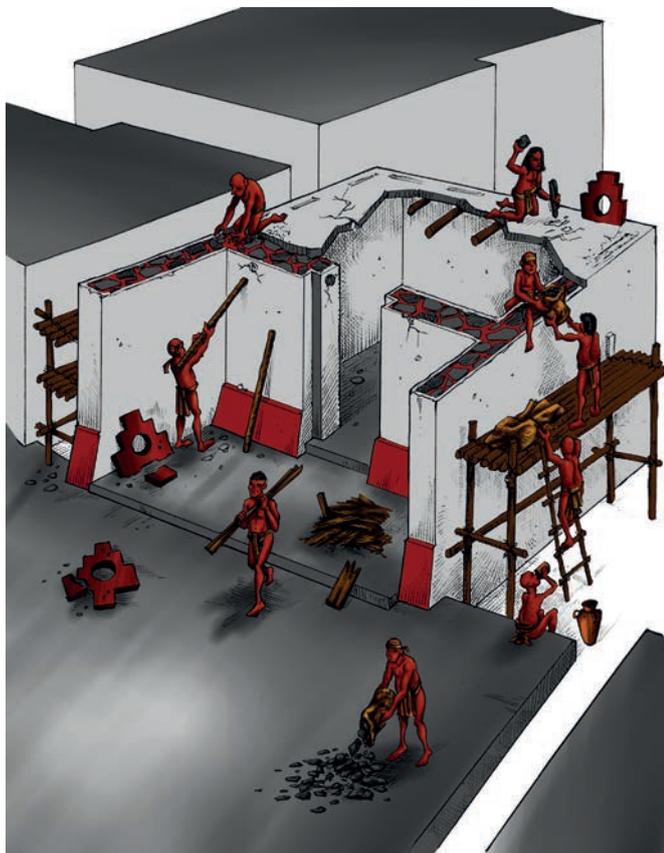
Proceso de demolición de losa y separación de materiales para su posterior reutilización. Dibujo reconstructivo de Víctor Germán Álvarez Arellano.
